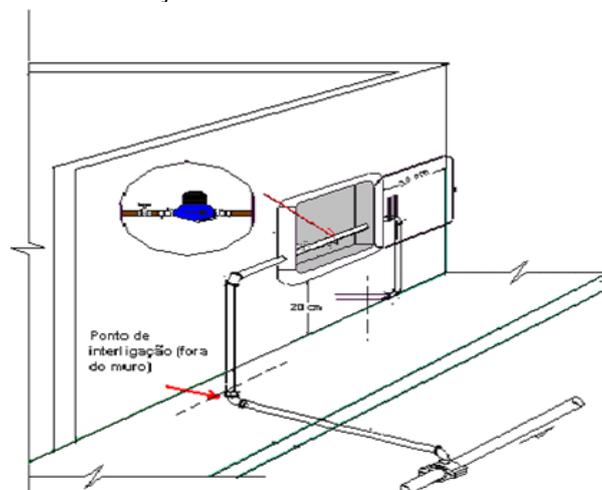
Modelo de instalação de hidrômetro no muro ou fachada.
